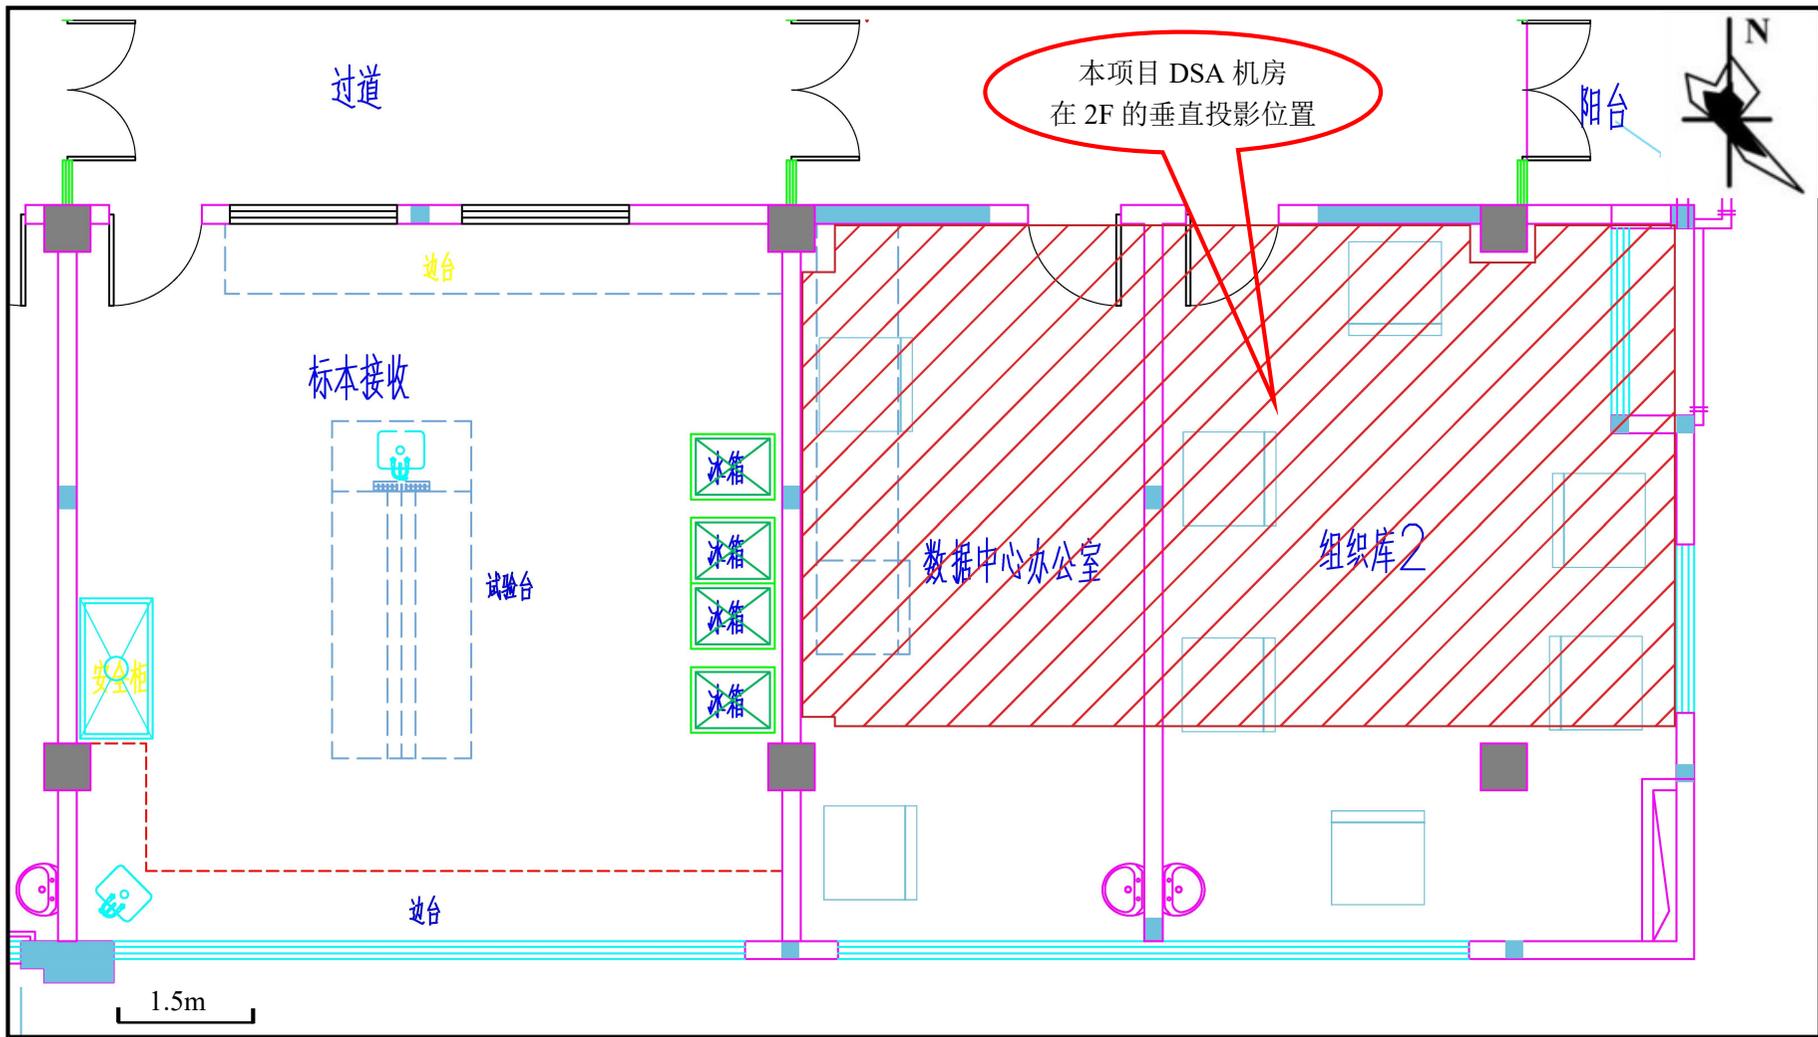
福建省肿瘤医院内科大楼 2 层（局部）平面布置图
